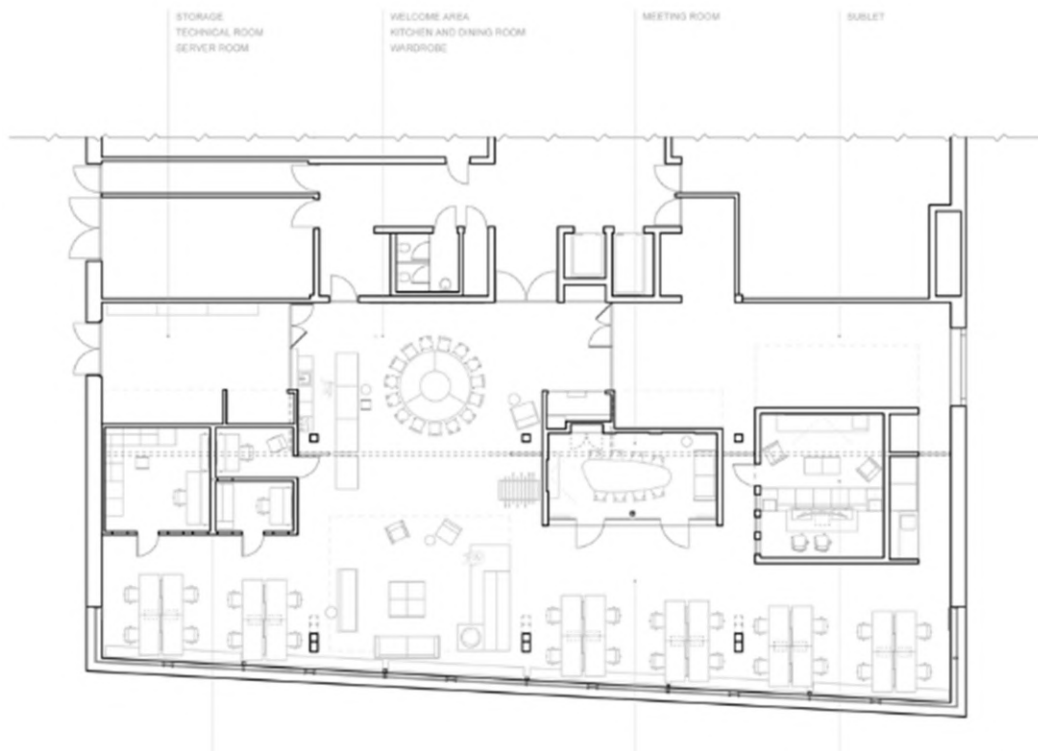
План першого поверху, Швеція, арх. Valbek bureau + EM2N, 2024 [4]
